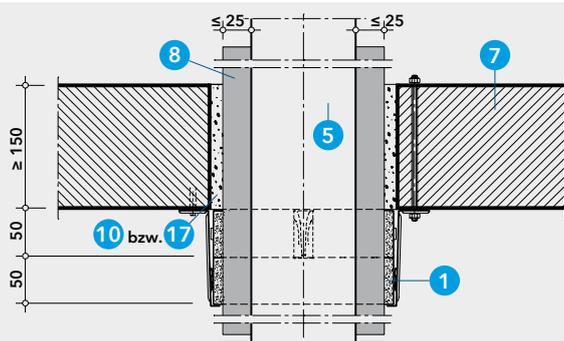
Detail K - Abschottung von Pythonleitungen (Getränkeschläuche)
